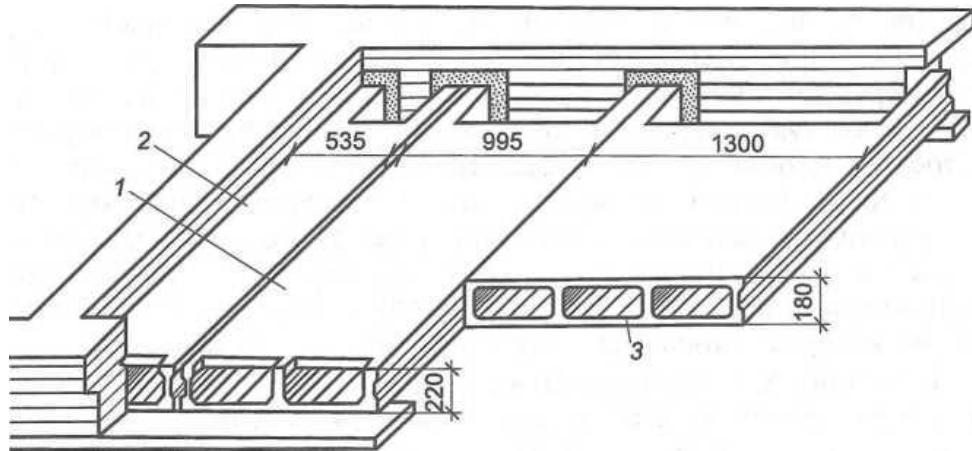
Вариант устройства междуэтажных перекрытий из сборных железобетонных настилов с выпускными ребрами:
